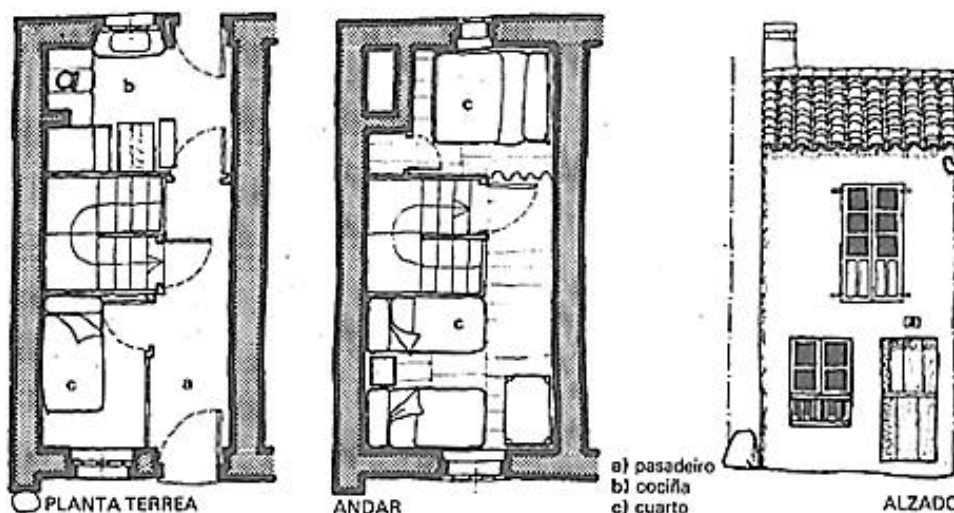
Plantas e Alçado da Casa Marín de Baiona
